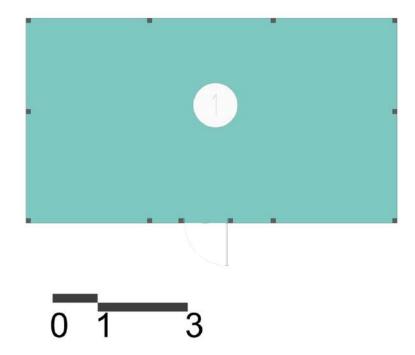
Planta 1 Bloque 33. Fuente: Equipo de diagnóstico.
